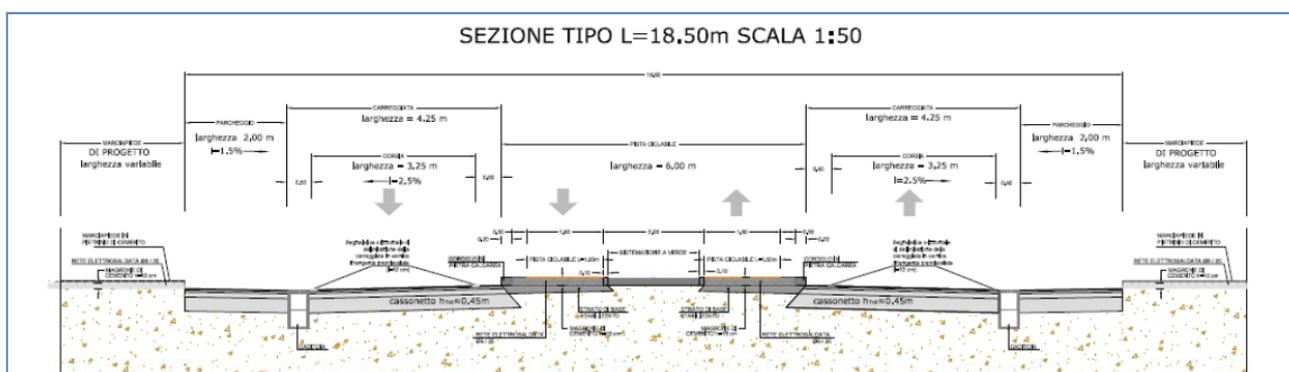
a-b Sistemazione tipo viabilità di progetto tipo D1
